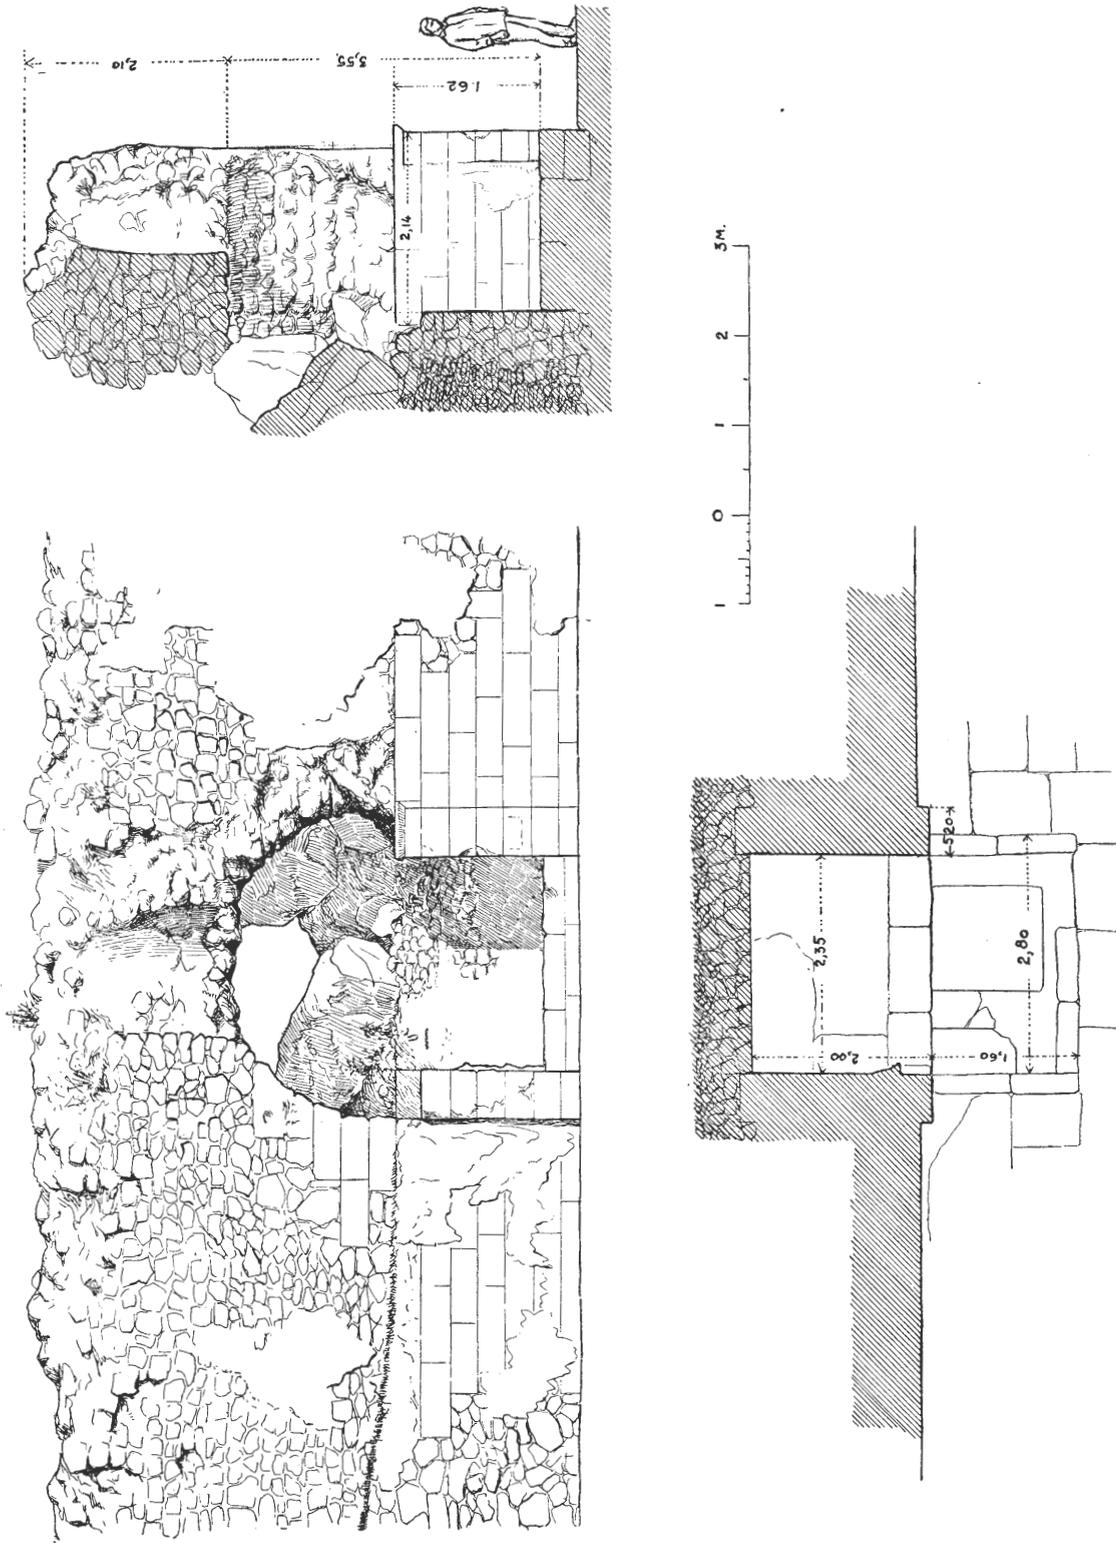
Plan, élévation et coupe de la niche (état actuel).
